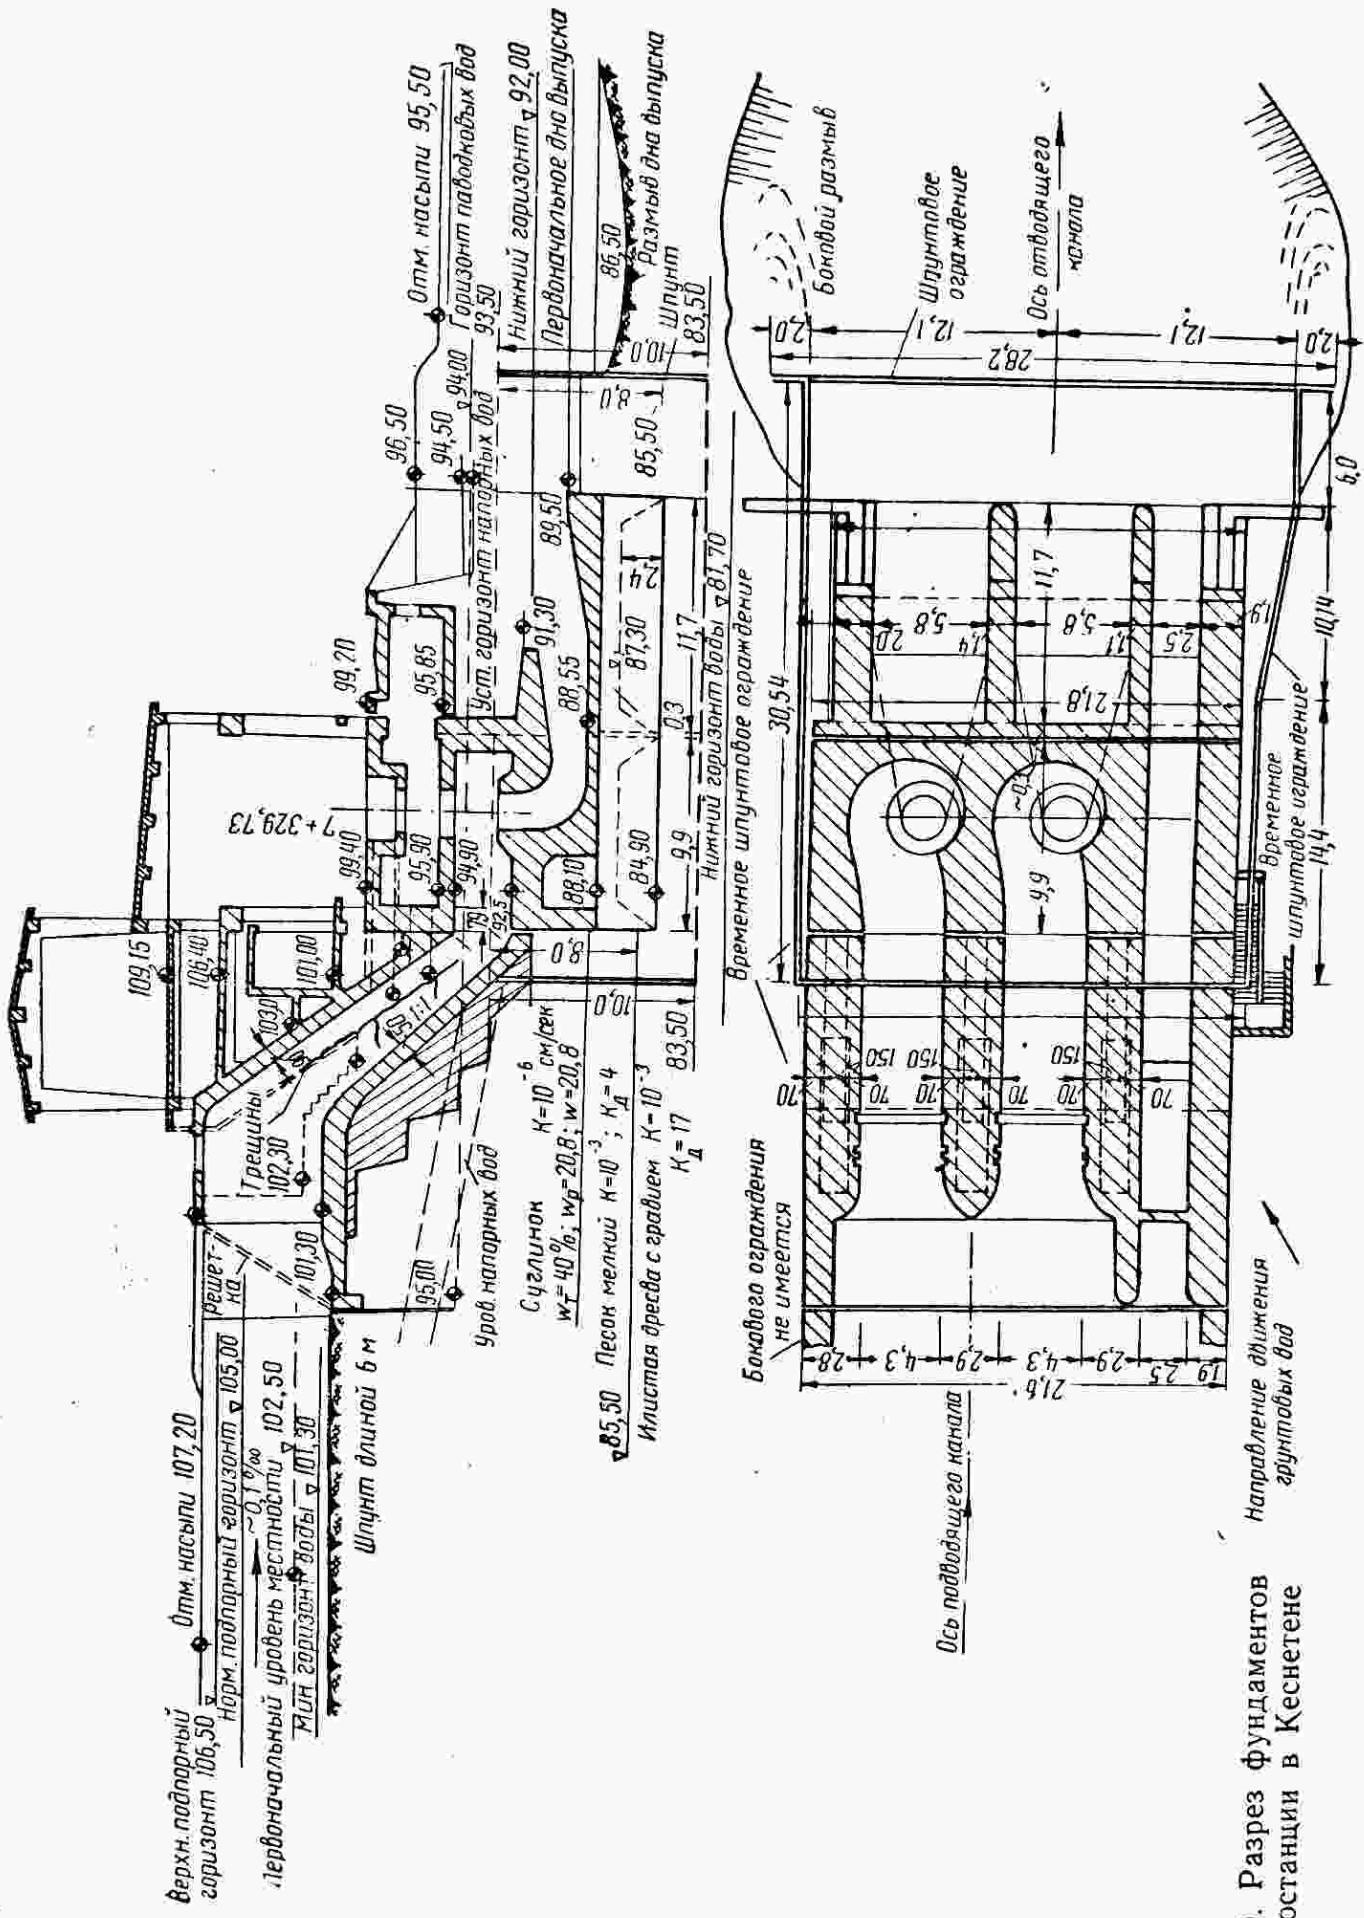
Разрез фундаментов гидростанции в Кеснегене
